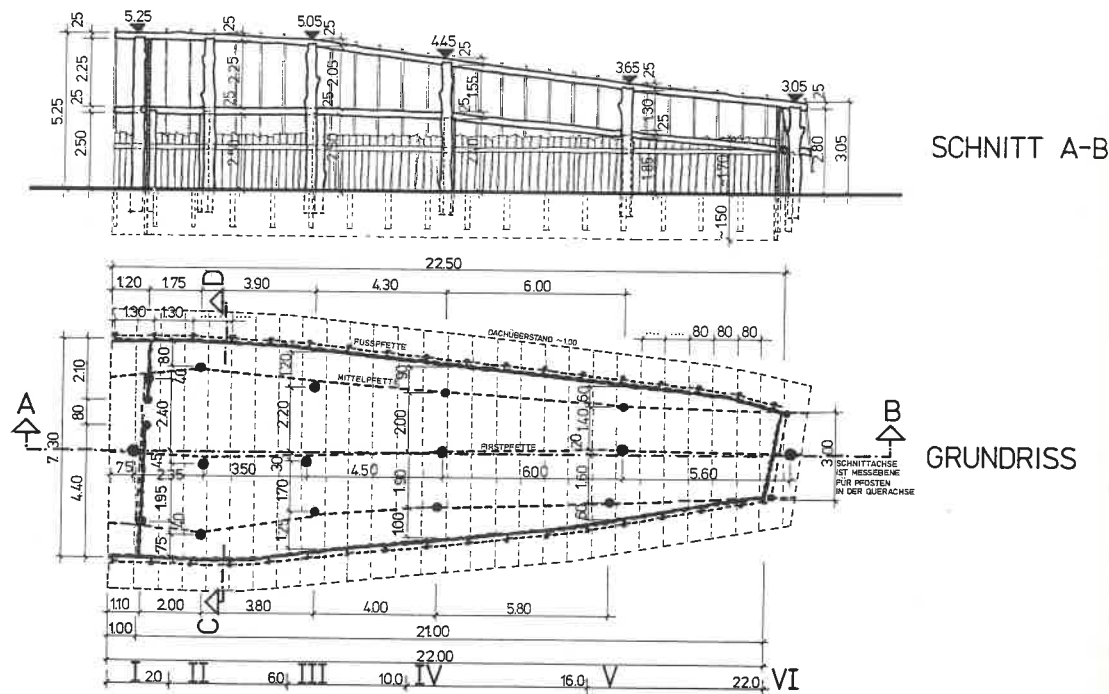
Rekonstruktionszeichnung: Inden 1, Bau-Nr. 9. Grundriß und Längsschnitt.
